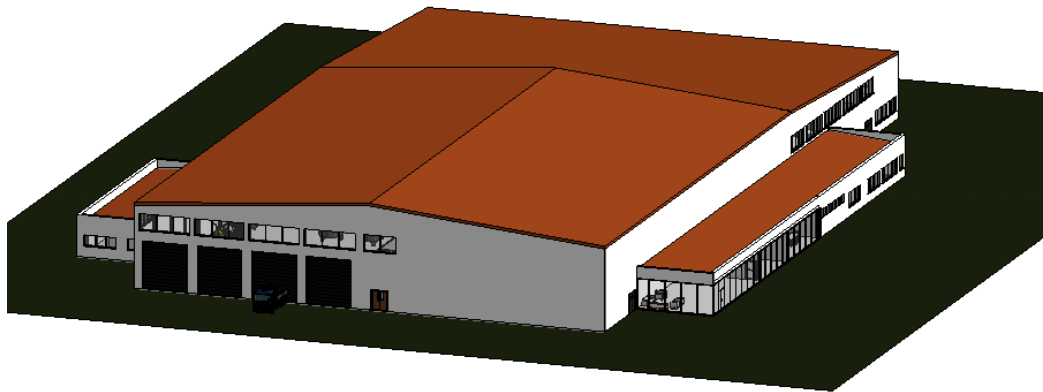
Modelo 3D de la bodega con vista de las cubiertas
